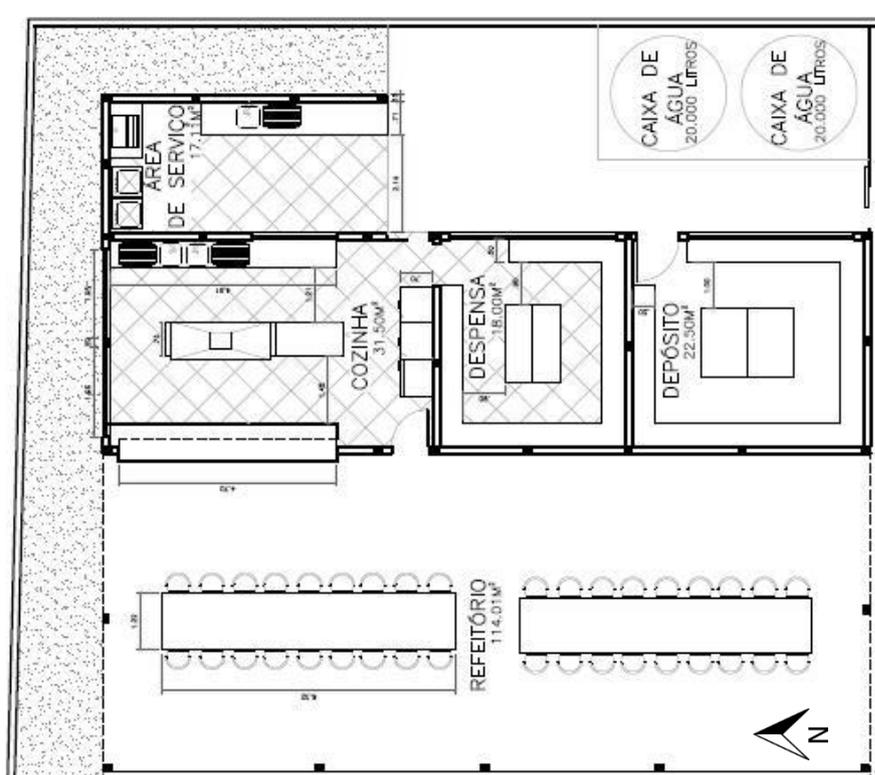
Planta baixa do setor de serviço-Prancha 3/5.
